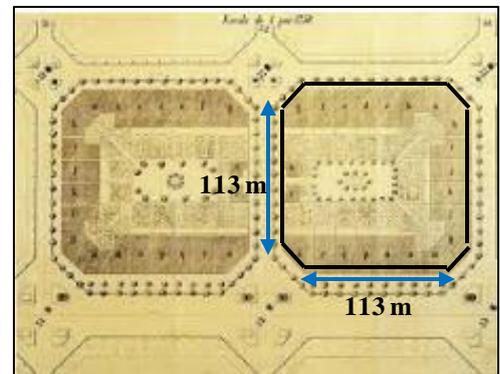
L'îlot dans le plan de Cerdà. Source : failedarchitecture.com
